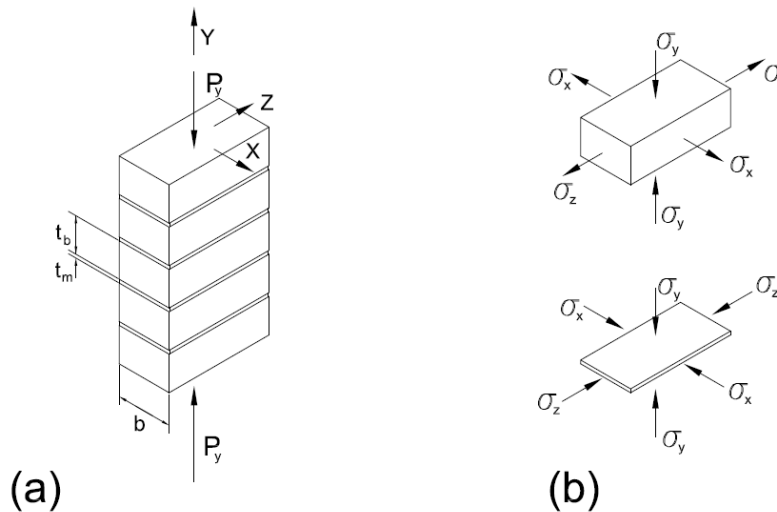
(a) Prisma sujeto a una fuerza vertical de compresión. (b) Estados de esfuerzo para las piezas y el mortero.
